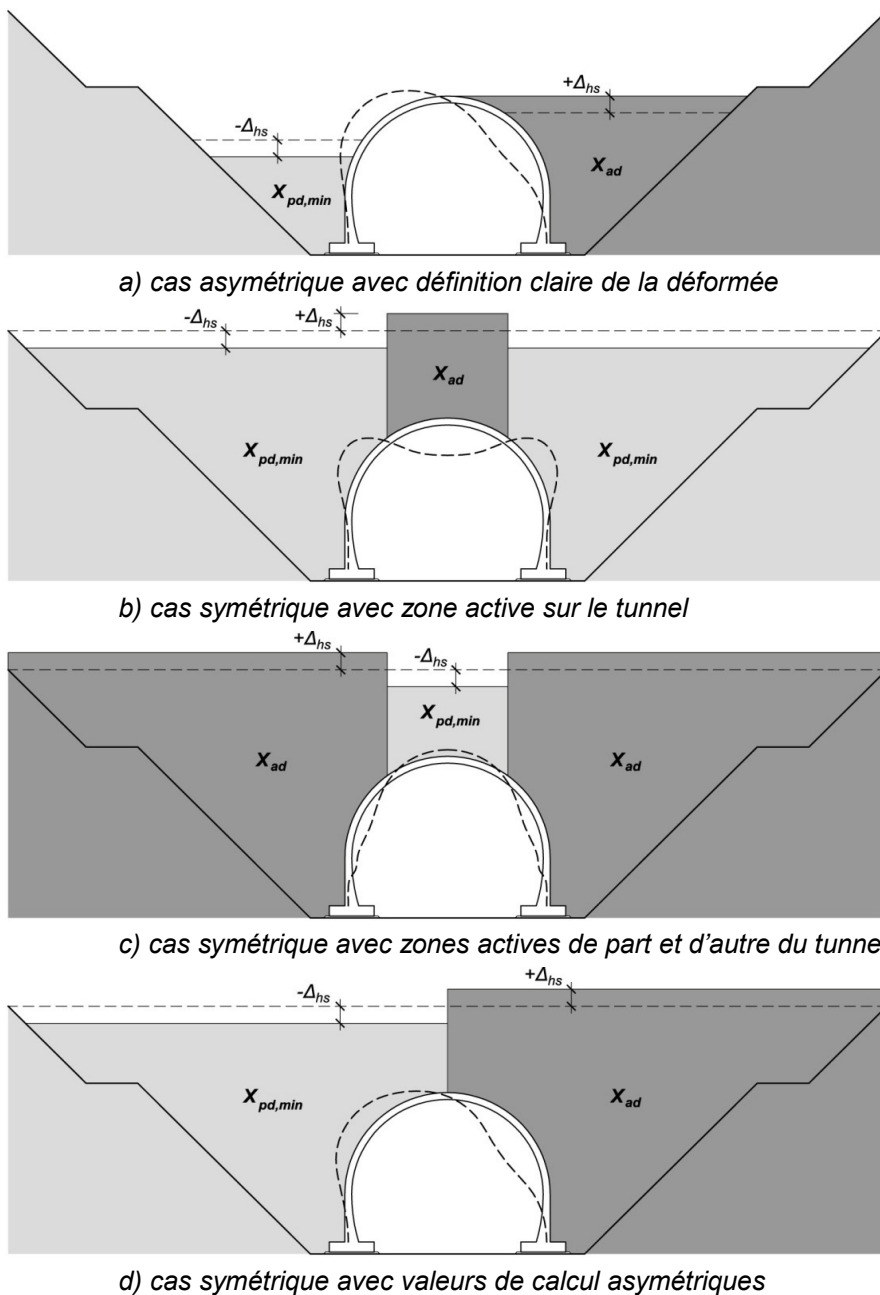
Exemples de choix des zones actives et passives dans les remblais d'une tranchée couverte en fonction de la déformée de la structure.
